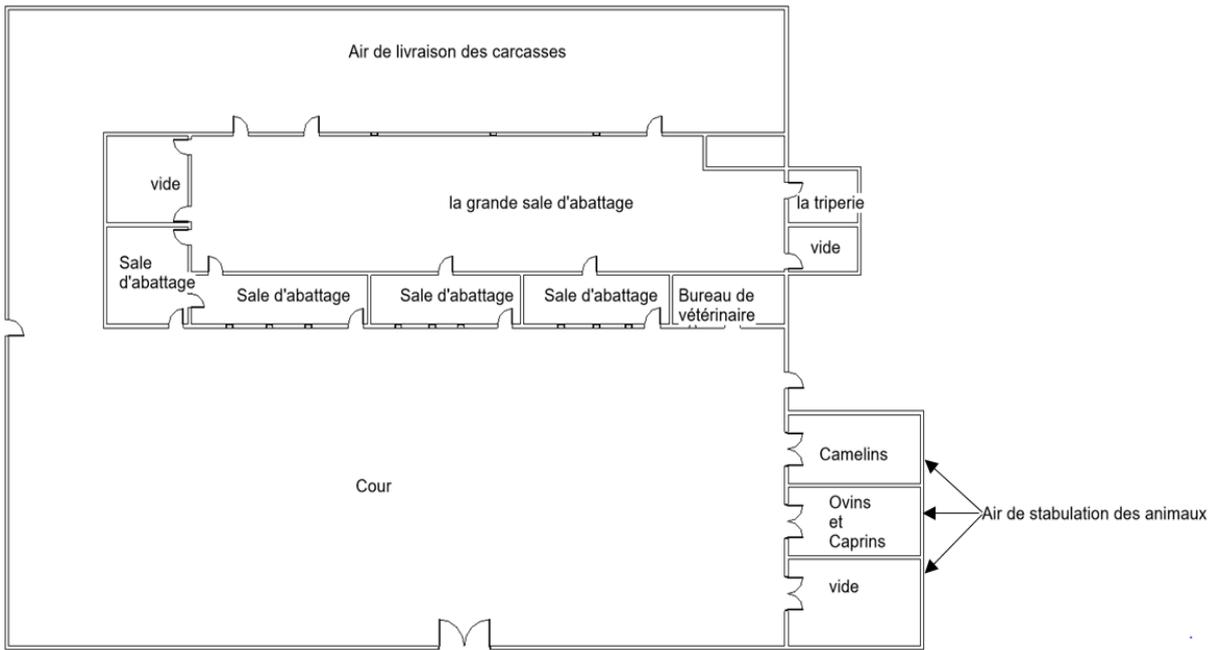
Plan de l'abattoir de Tamanrasset (Travail personnel).
